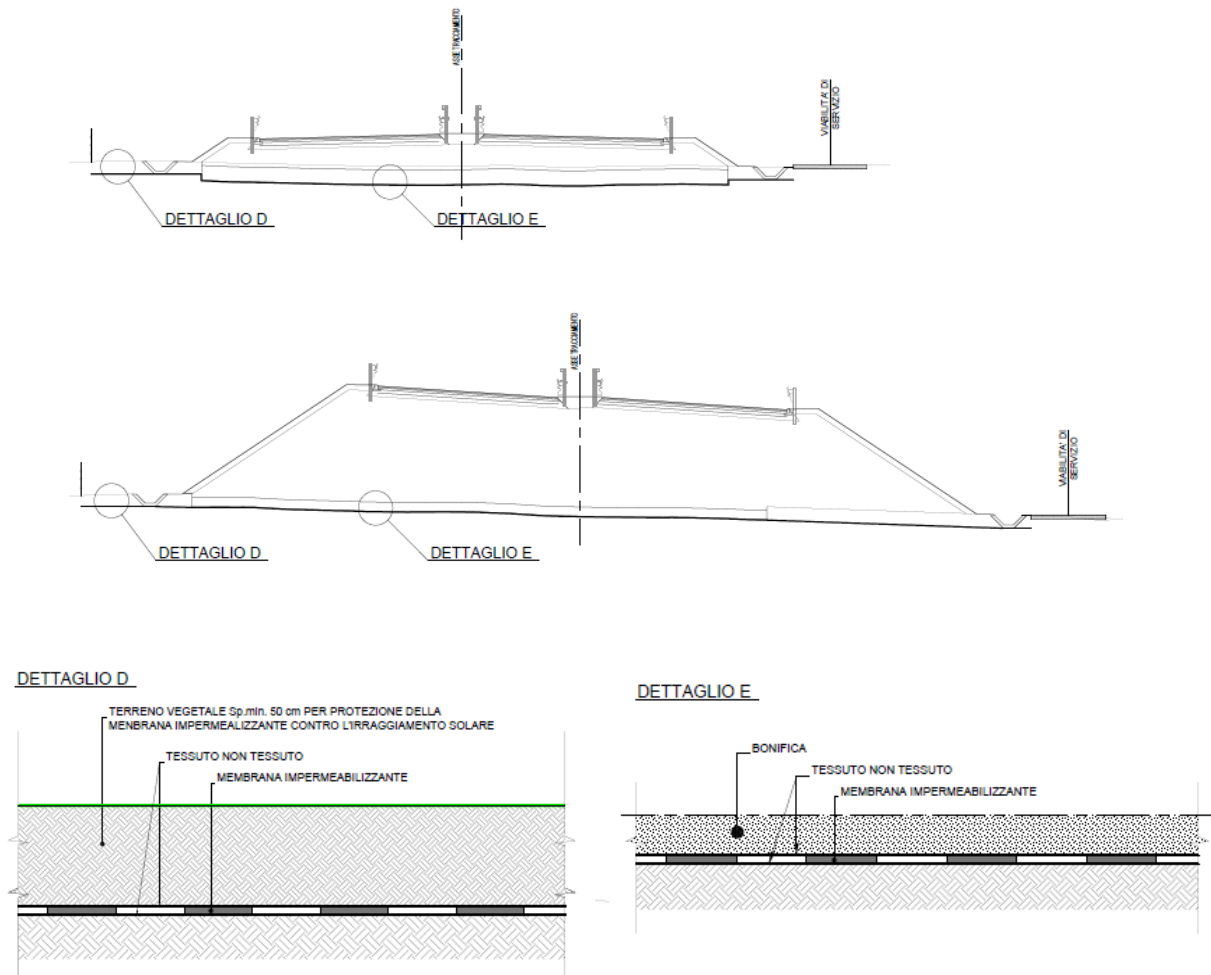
Sezione tipo pavimentazione presso interferenze poligoni Pz102bis e Pz098
